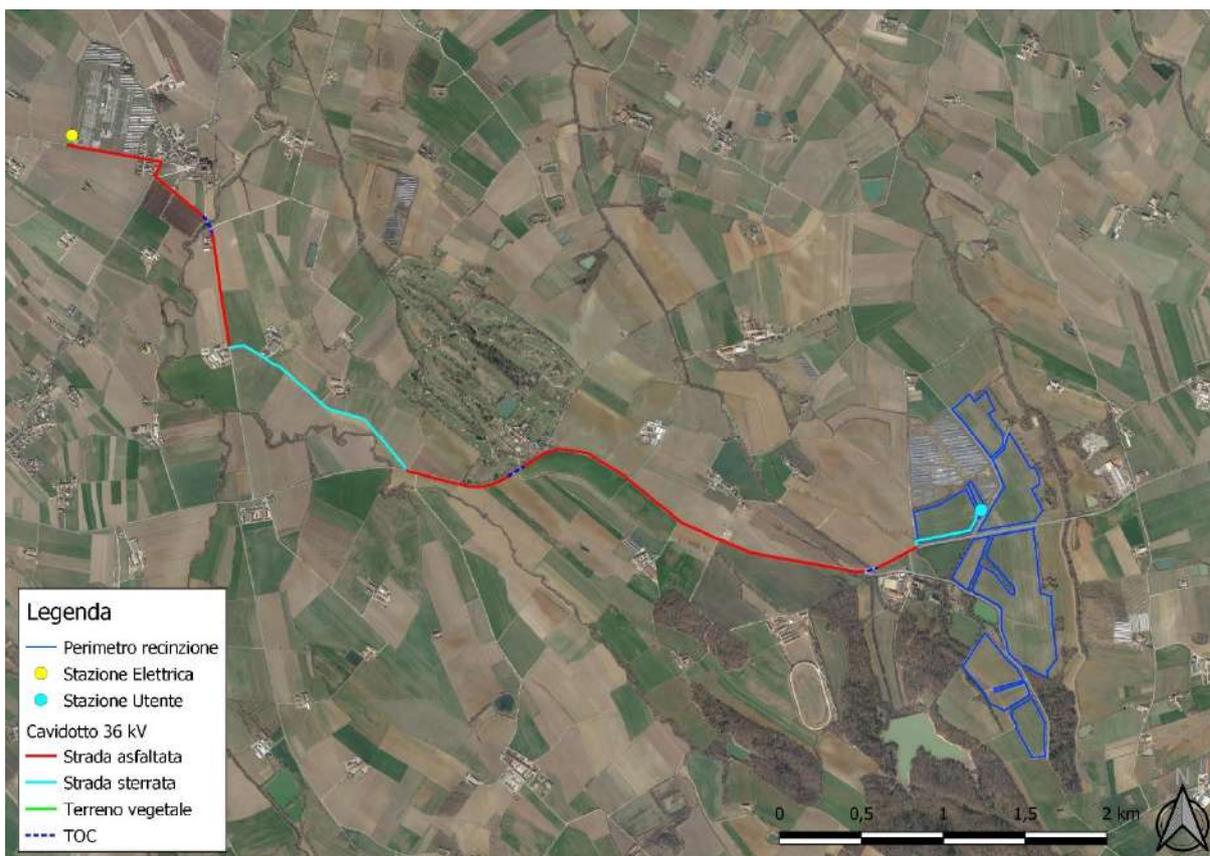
Planimetria su Ortofoto del Cavo di Connessione
